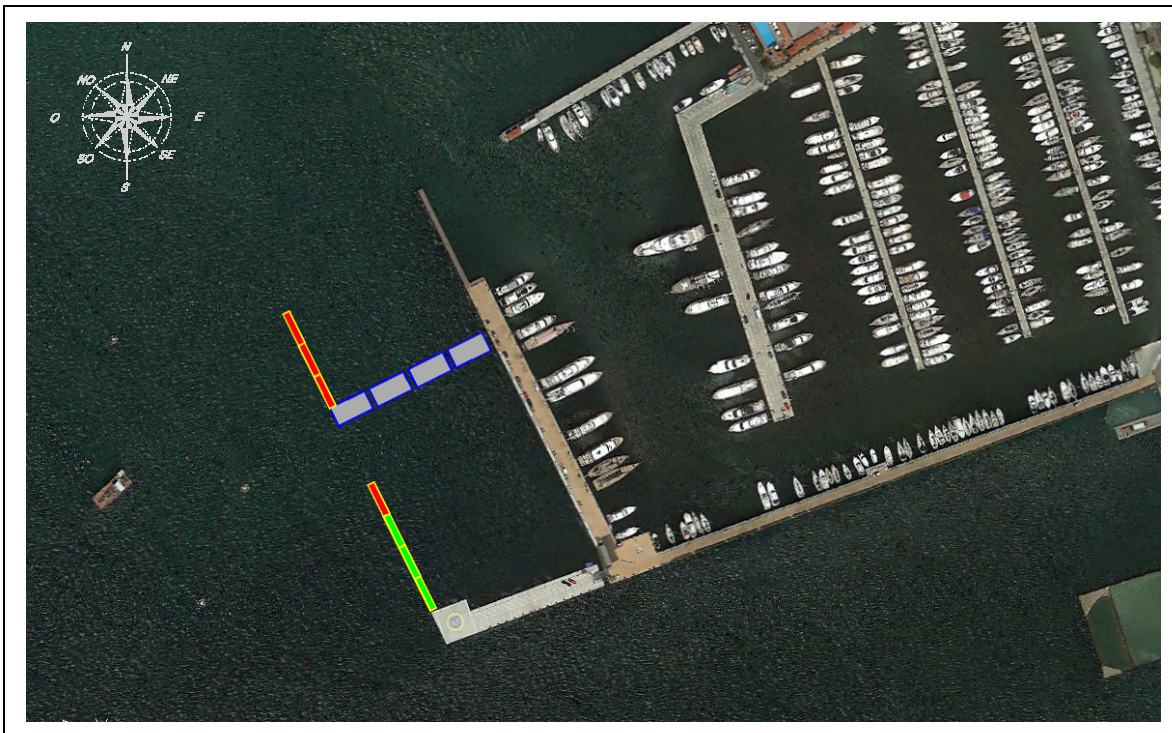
Layout della prevista espansione di Porto Lotti nella fase 2
